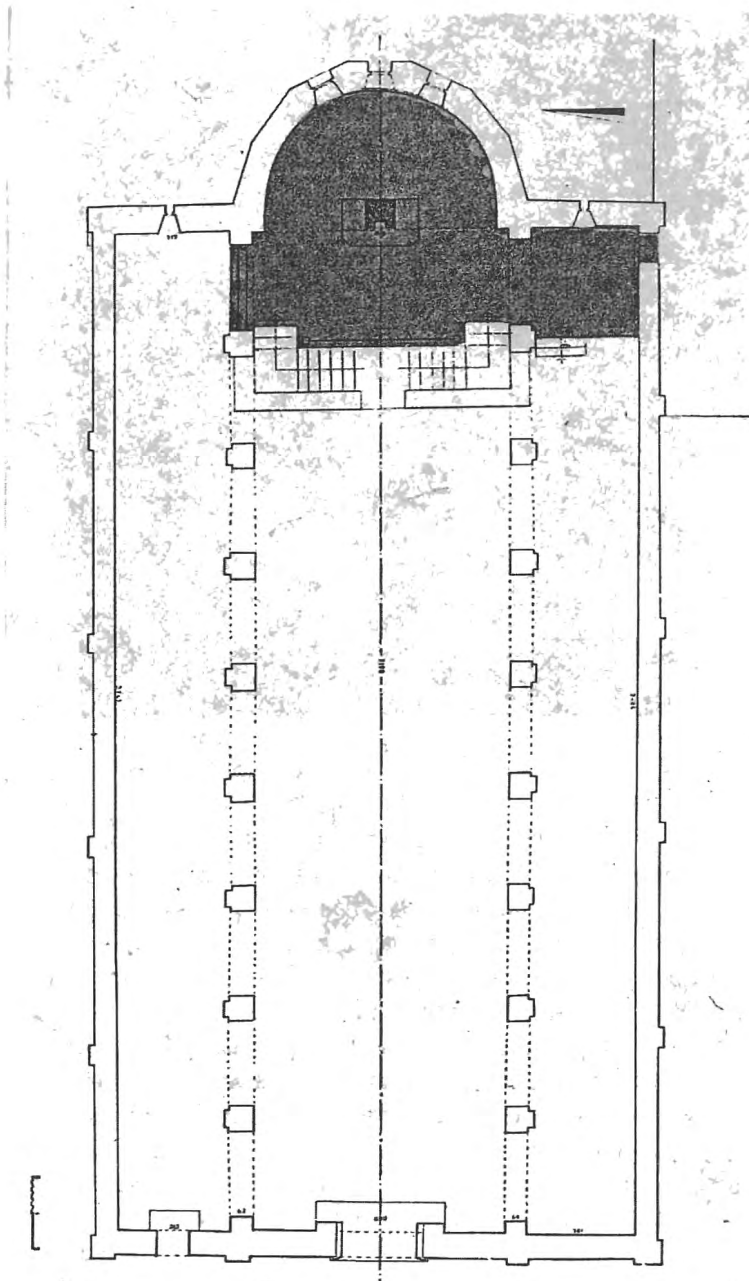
Bagnacavallo, Pieve di S. Pietro in Sylvis: pianta dell'edificio.
